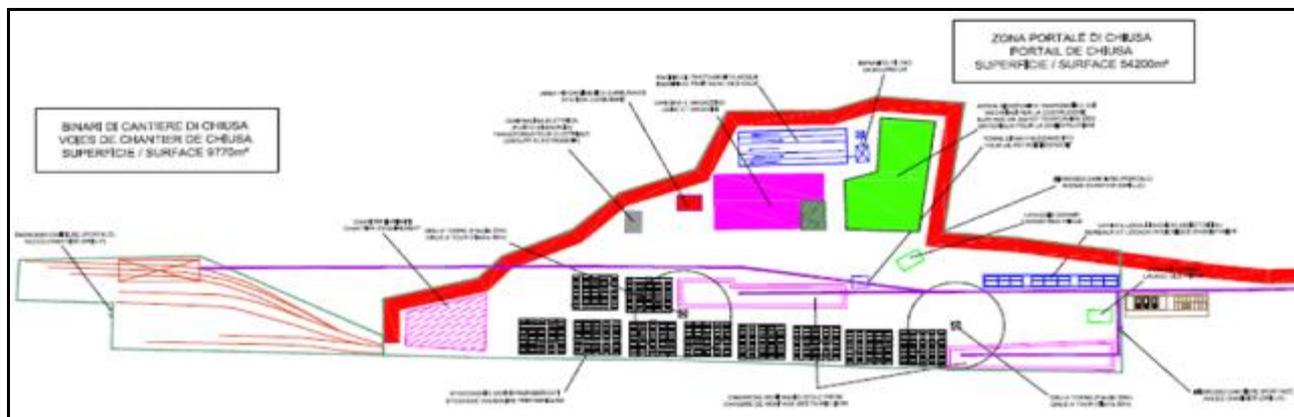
Layout dell'imbocco est del tunnel dell'Orsiera.
